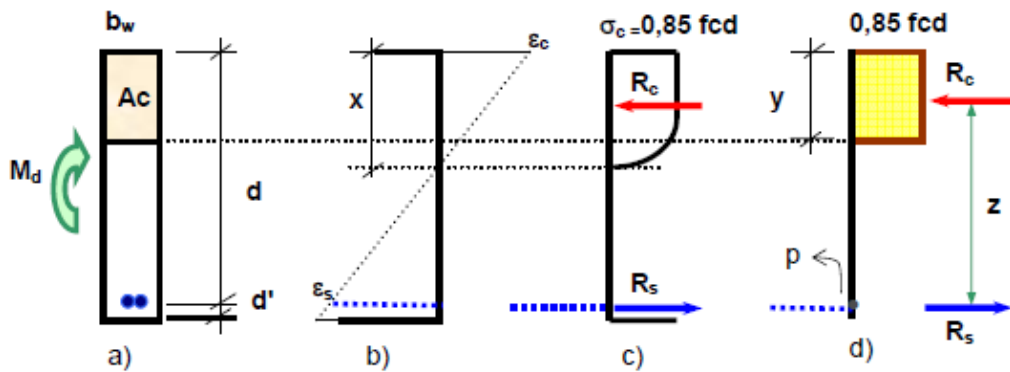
Binário interno para seção retangular sob a ação da flexão simples. Apostila Concreto Armado UFF
